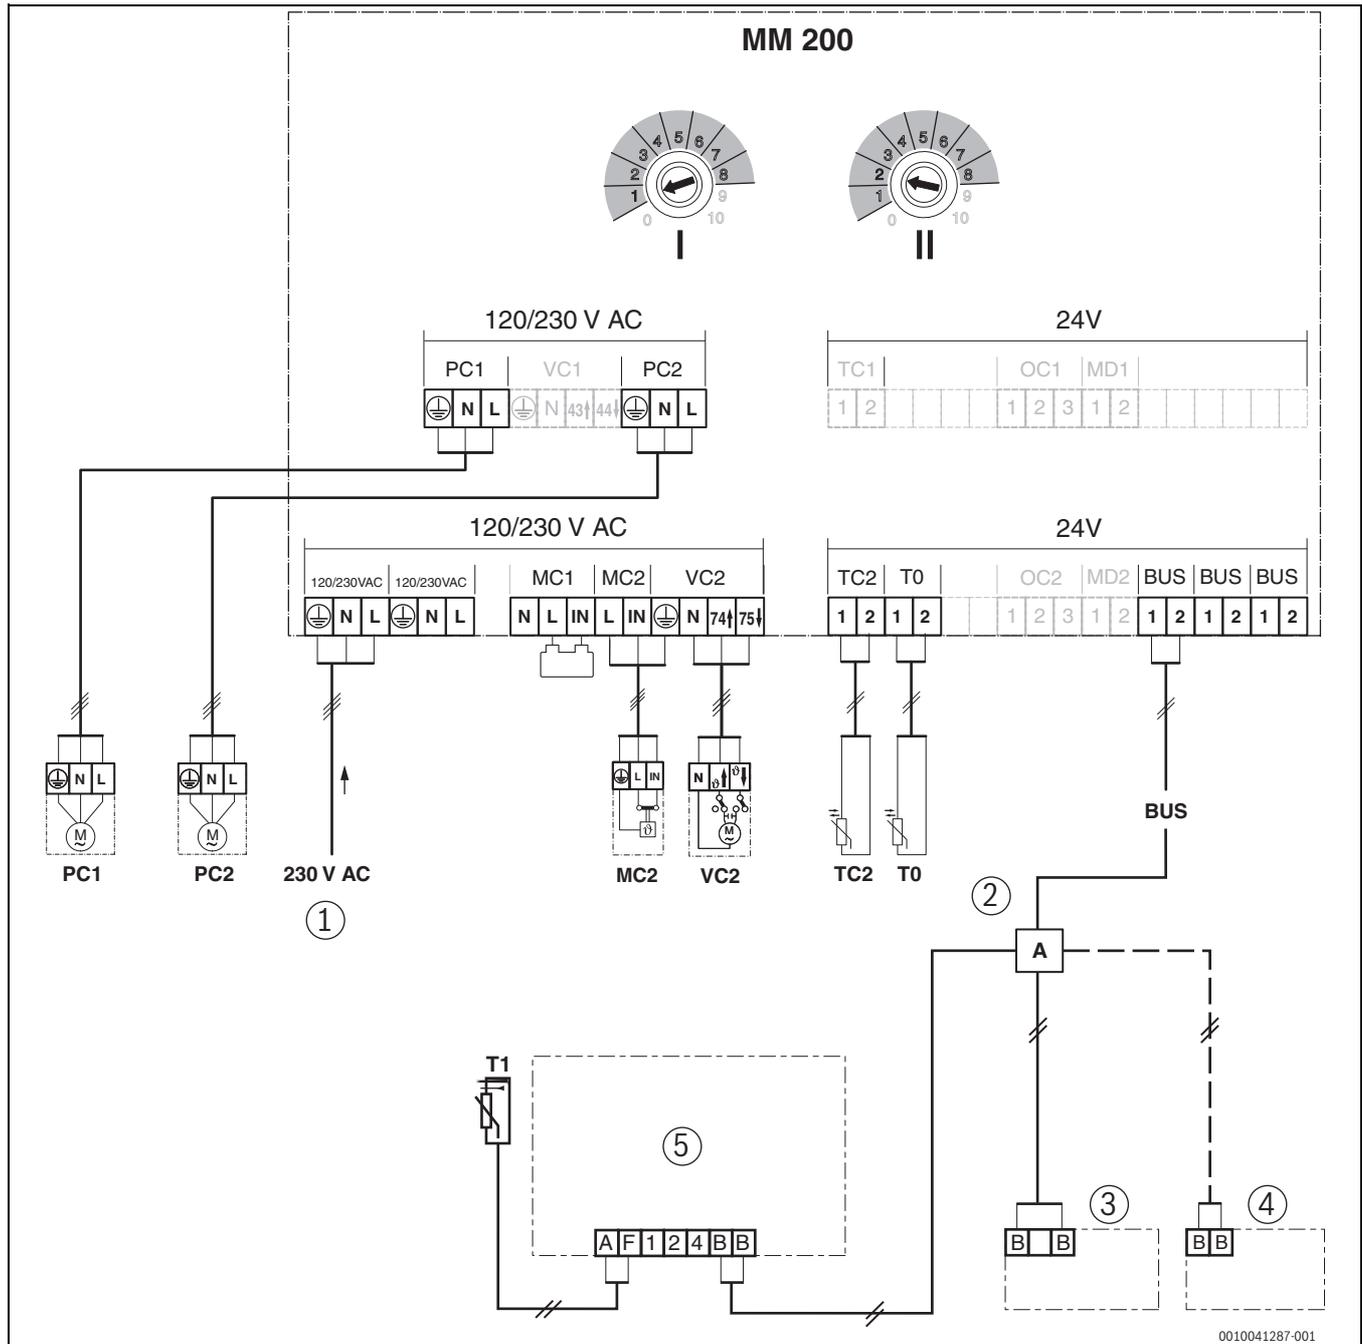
Anschlussplan HSM2-U 20/7 MM200
